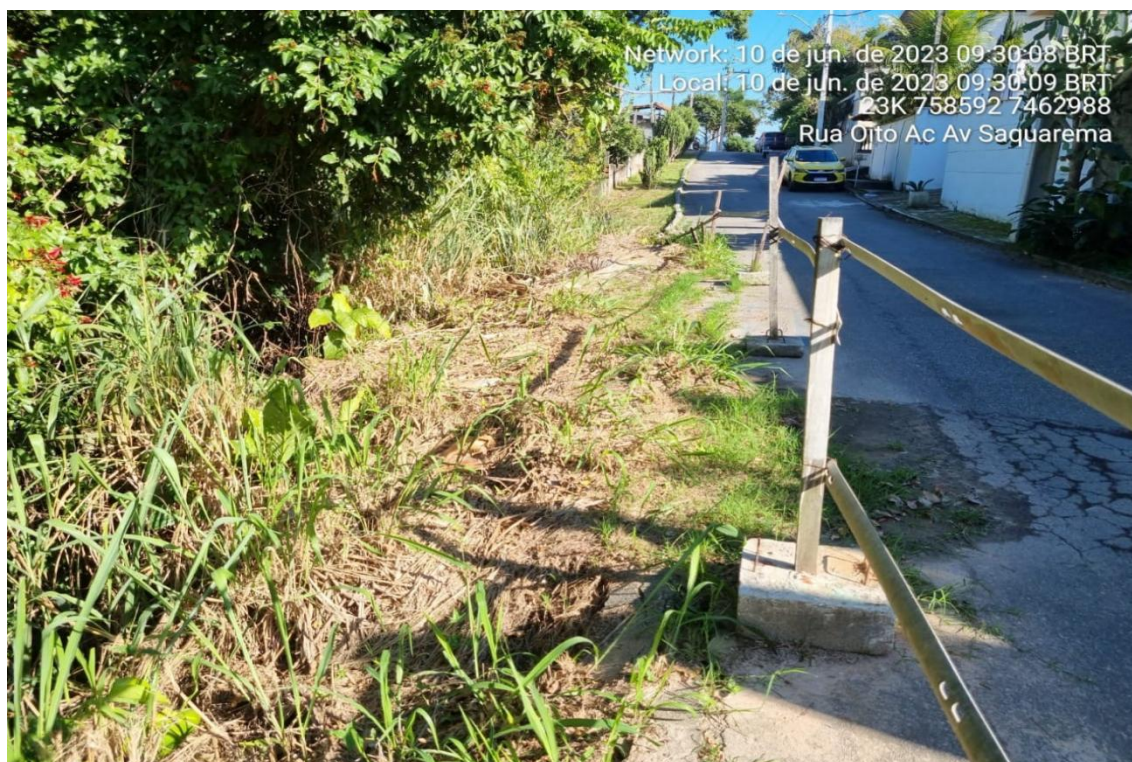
Foto do local de topo da erosão e das trincas no pavimento. Fonte: Vistoria
